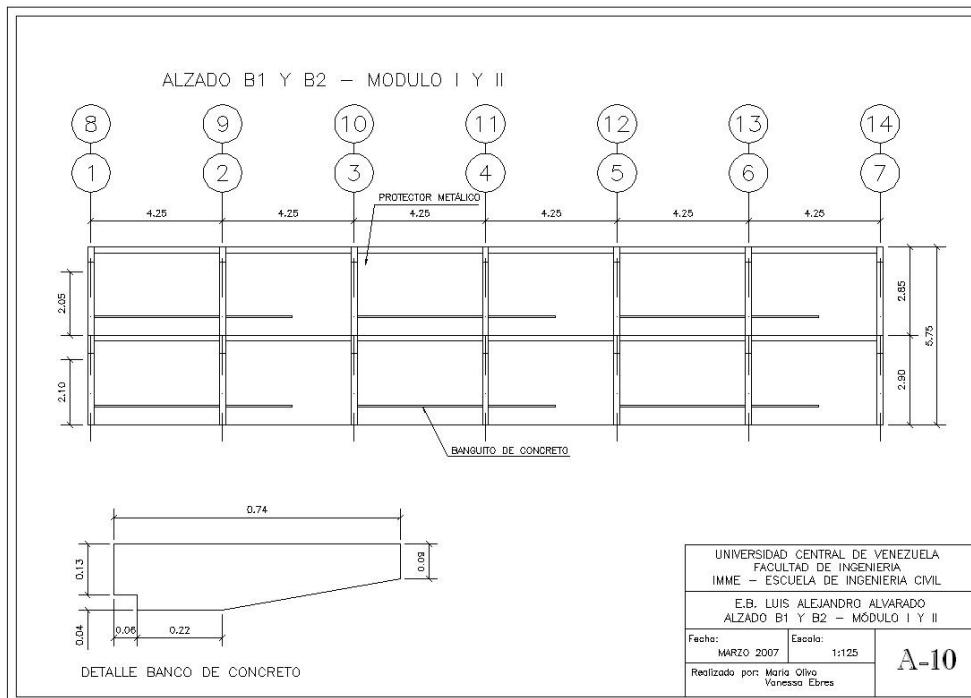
Plano de la Fachada Norte del Módulo II.
